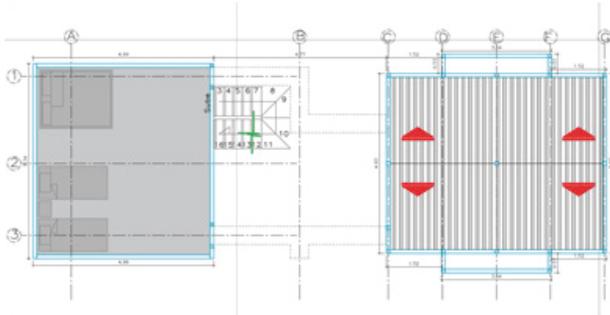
Planta arquitectónica de mezanine vivienda modular sostenible
